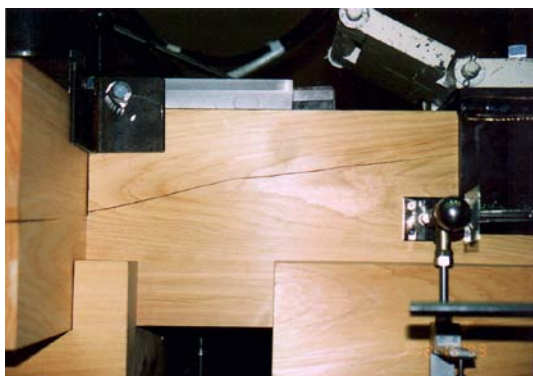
通し肘木のひび割れ(南面・東側)
